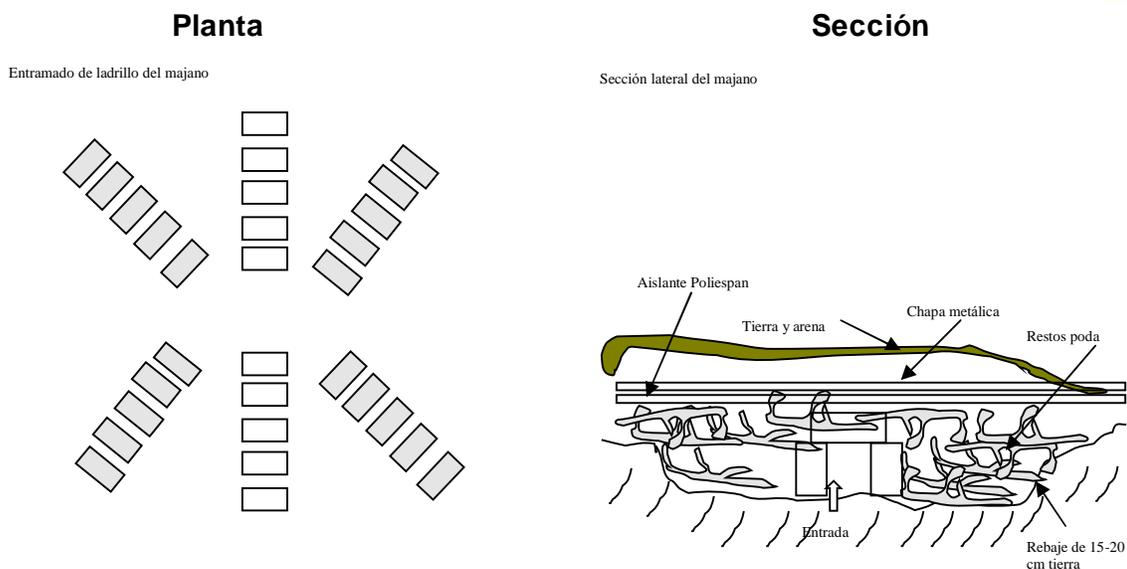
Planta y sección de un majano de piedra (Modelo A).
